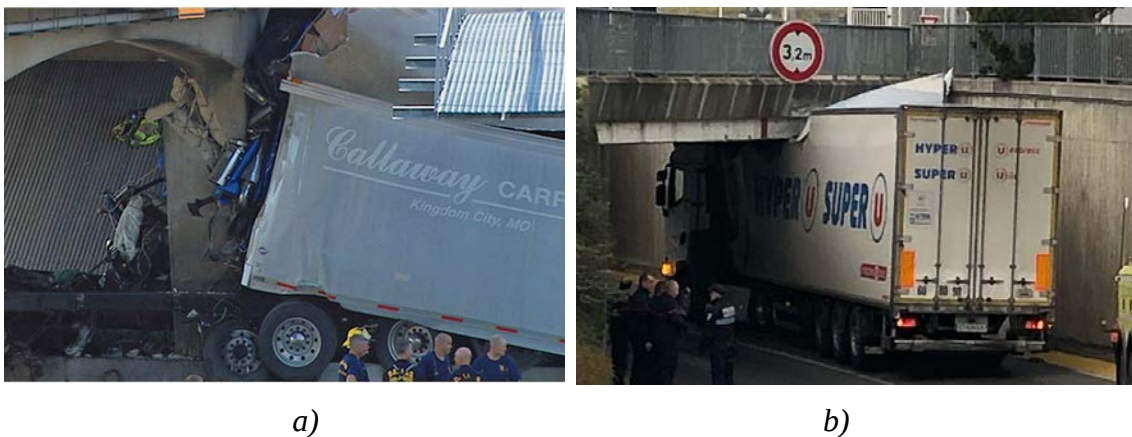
Situations de collision de véhicules avec des ouvrages d'arts a) poteau d'un pont et b) poutre d'une passerelle en béton armé.
